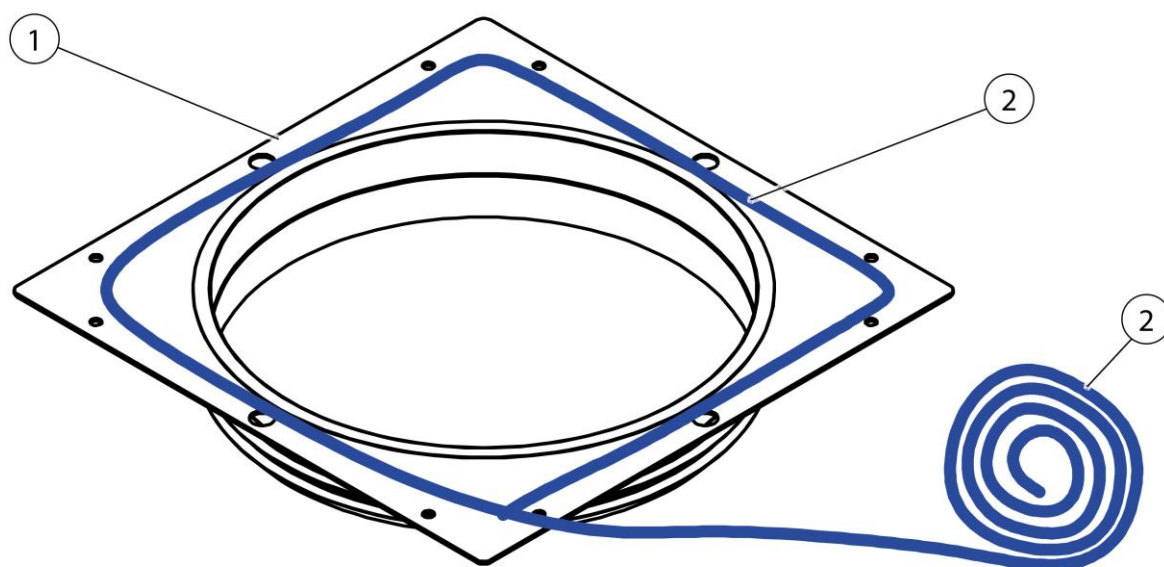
Монтаж – присоединительный патрубок, приклеивание уплотнительной ленты
